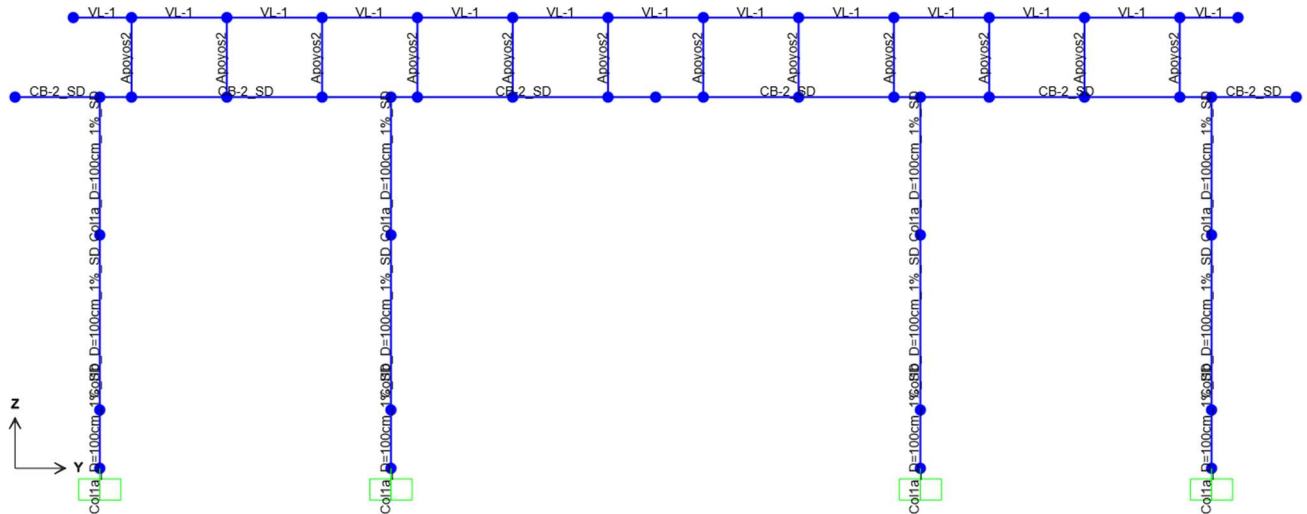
Puente Santo Domingo, elementos estructurales del marco M-2
